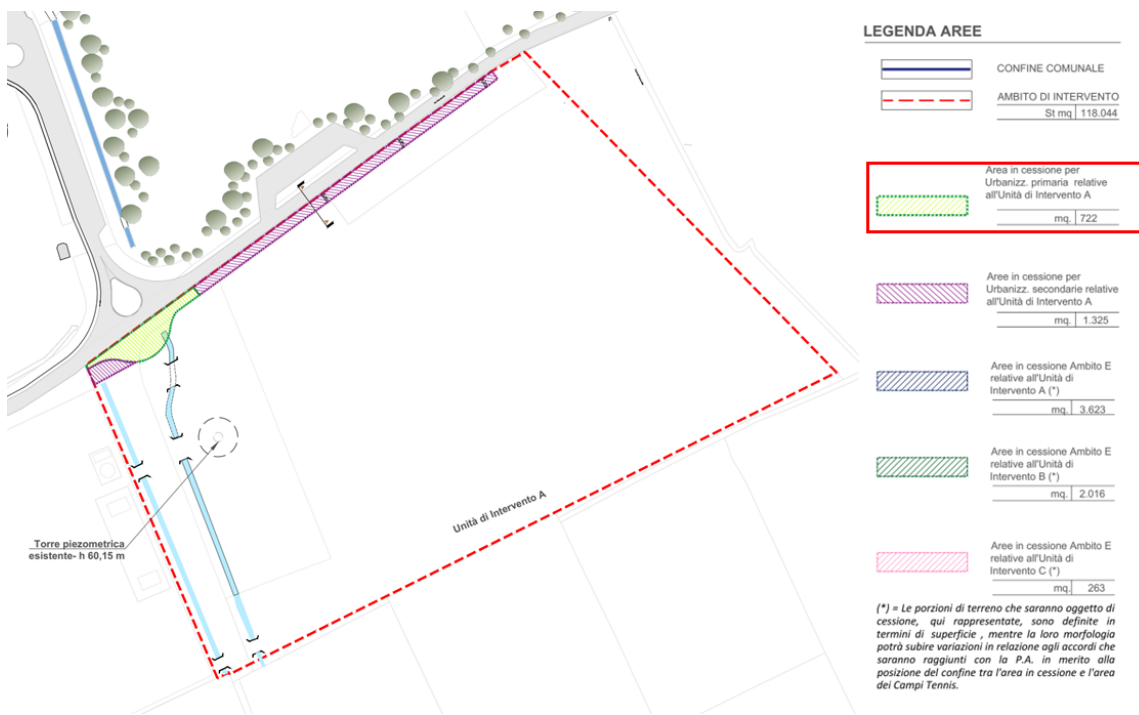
Estratto della Tavola 09 – “Planimetria generale con individuazione delle aree in cessione” del PUA
